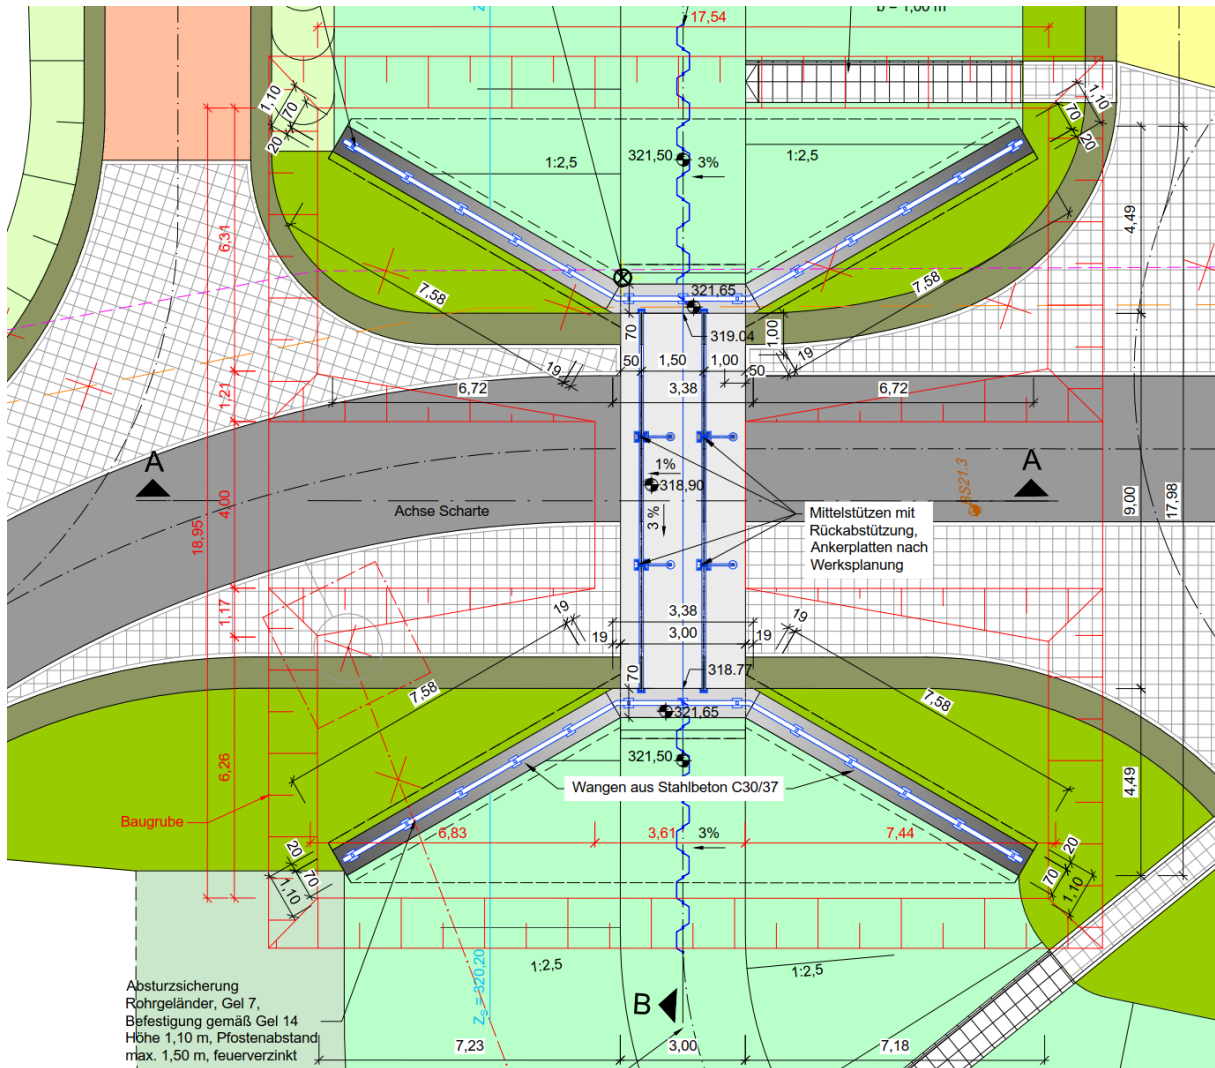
Deichscharte Breitenfeld, Grundriss (aus Plan 04-06-05, Blatt 4/4)
